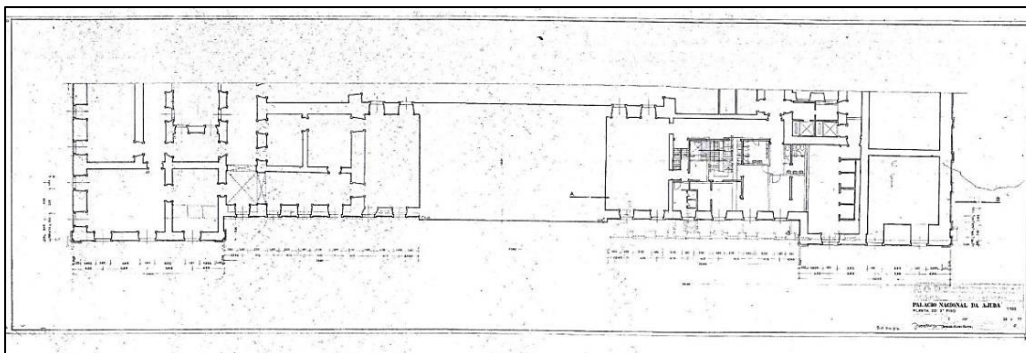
Planta do 2.º piso da Ala Poente. Projeto de João Seabra, 1977.
